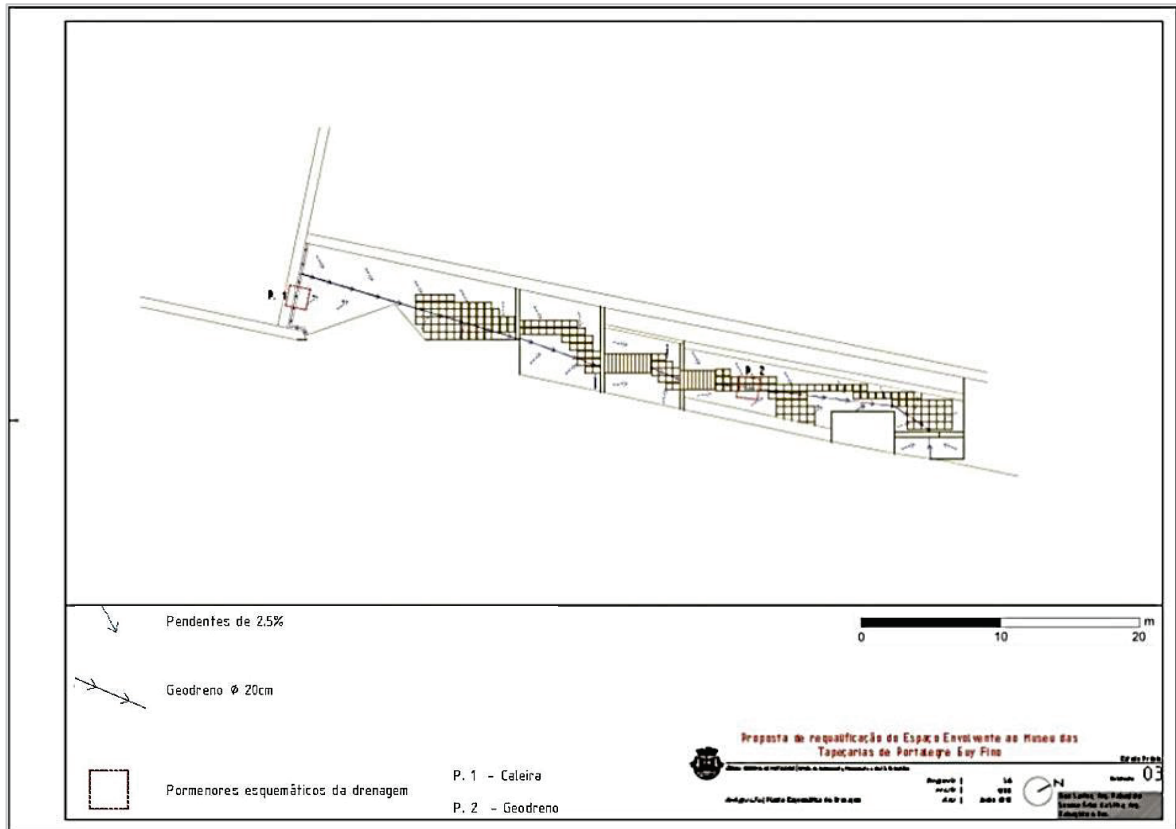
Carta 03 - Planta Esquemática de Drenagem
